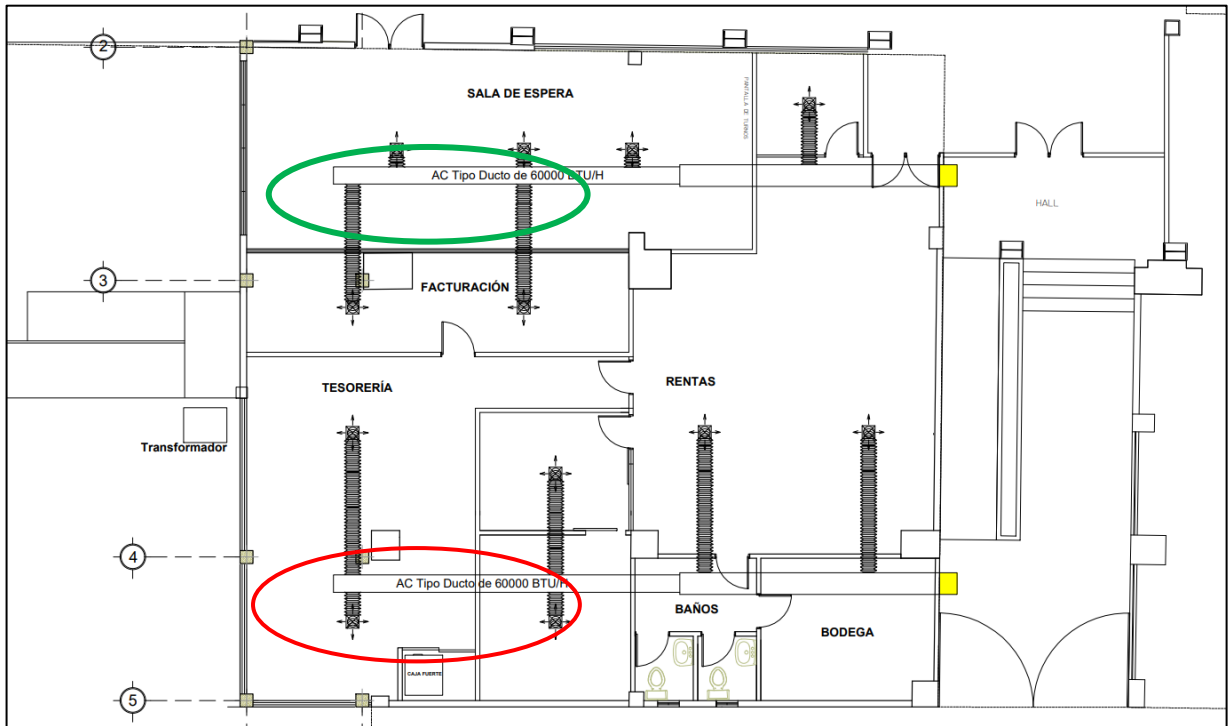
Plano de Climatización – Planta Baja [2]
